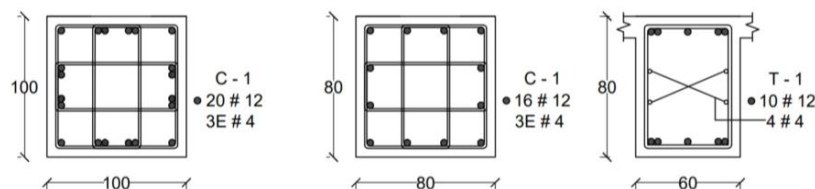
Detalle de los elementos estructurales para ambas estructuras
